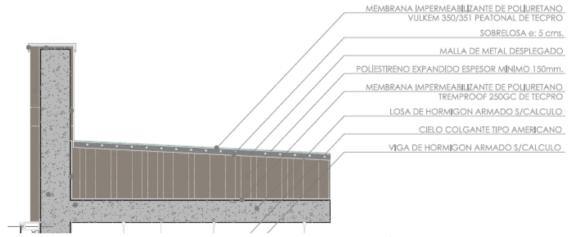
Detalle constructivo de techumbre Fiscalía Local Talcahuano
